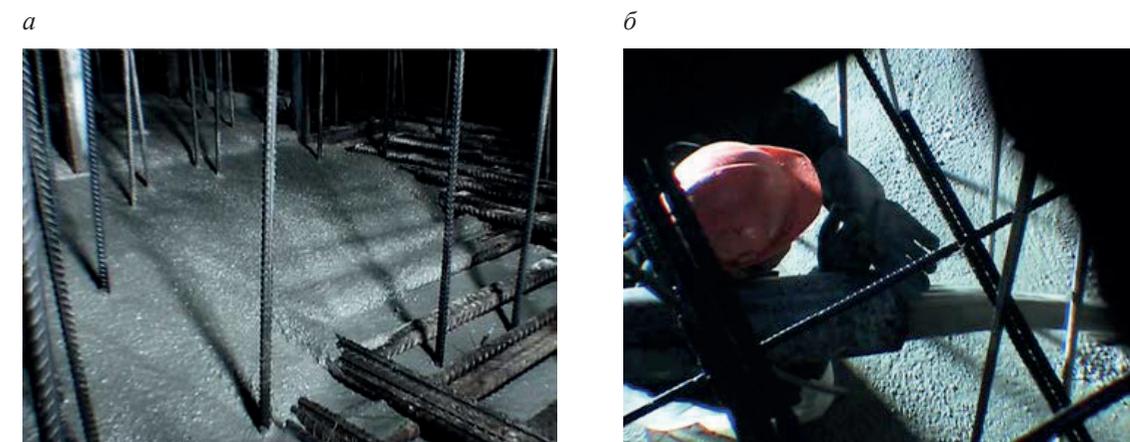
Укладка самоуплотняющейся бетонной смеси в нижнюю густоармированную зону фундаментной плиты Башни «Восток» высотного комплекса «Федерация» на участке №13 ММДЦ «Москва-Сити» (средний расход арматуры 270 кг/м³, класс бетона В50, объем бетонной смеси 14,2 тыс. м³):
